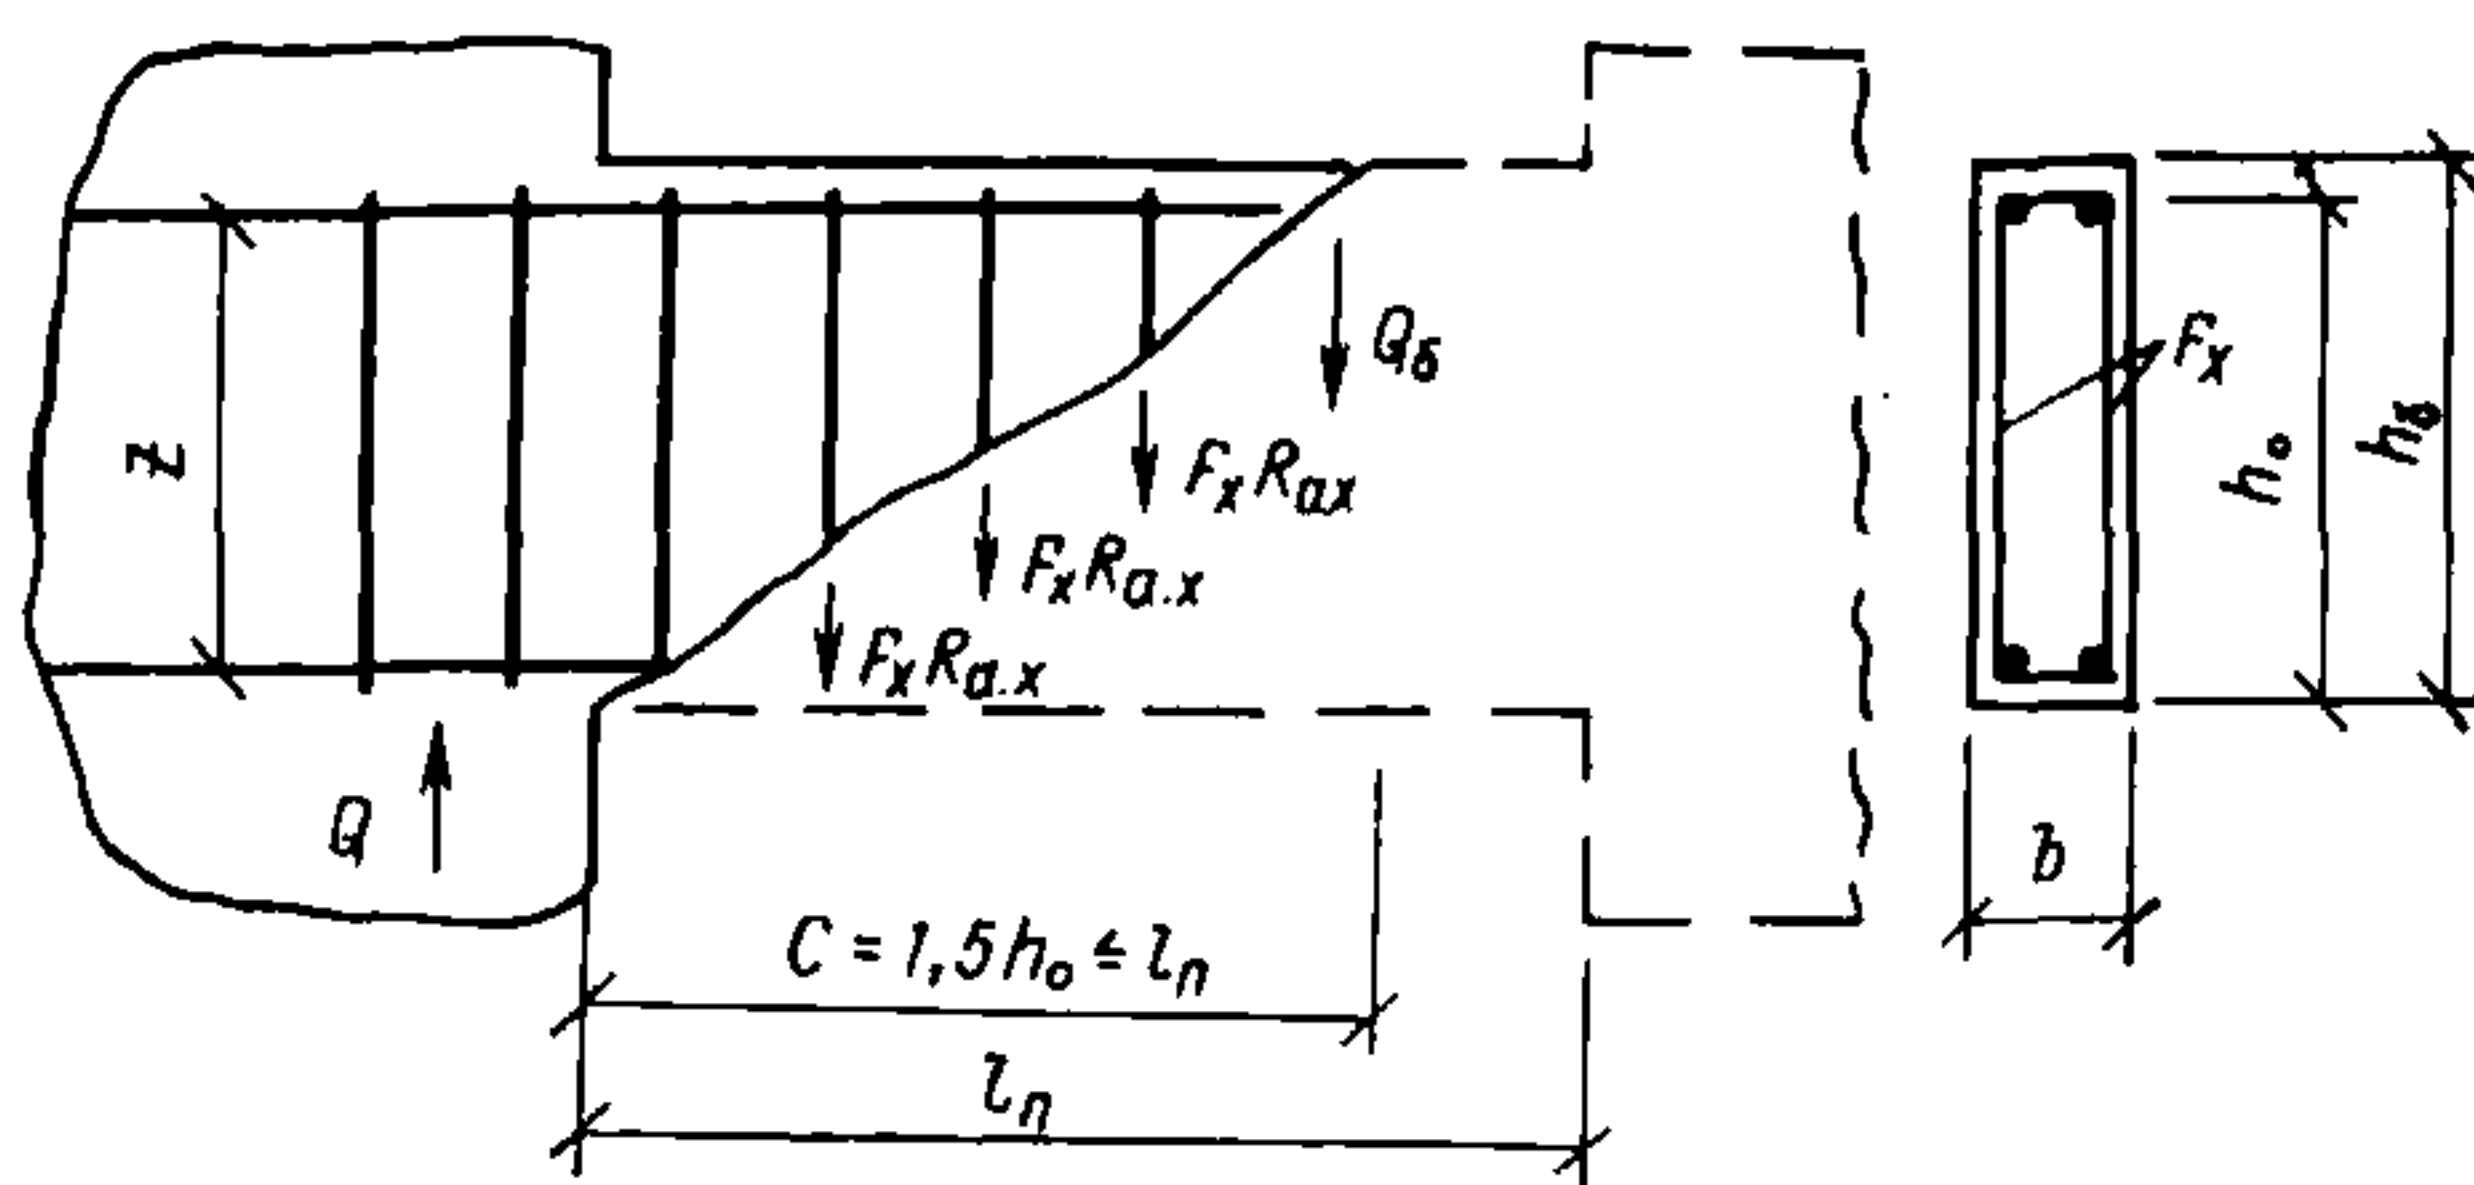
Расчетная схема перемычки на действие поперечной силы
